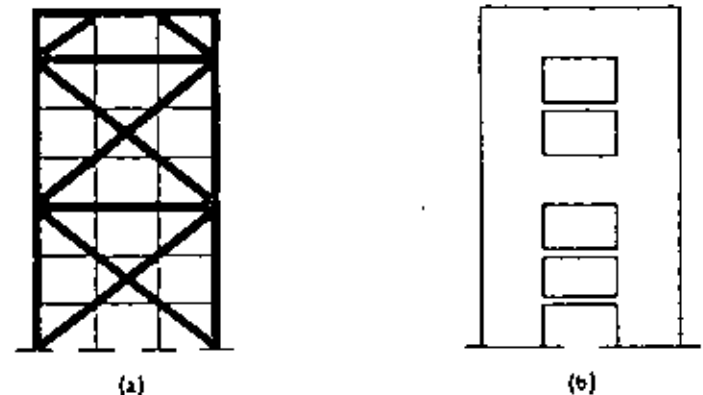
Uso eficiente de elementos rigidizantes. a) Contraventeo en cruz, b) muros de cortante y vigas de acoplamiento.
